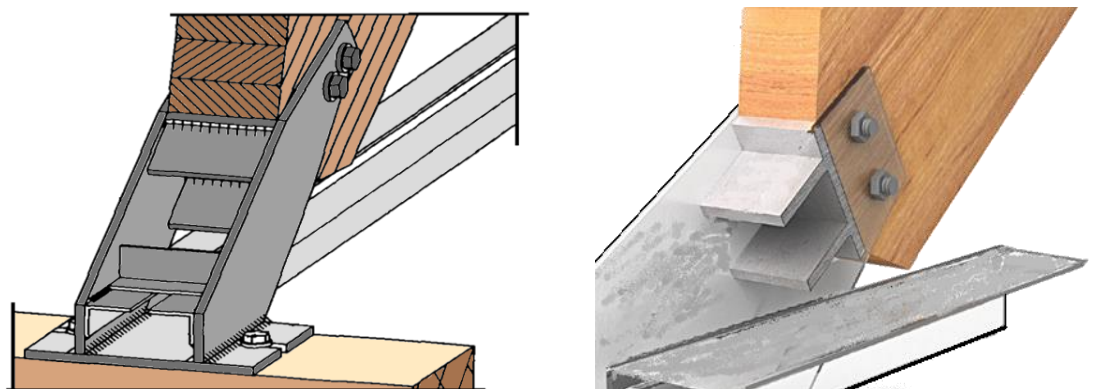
Конструкция опорного узла сегментных фермы
